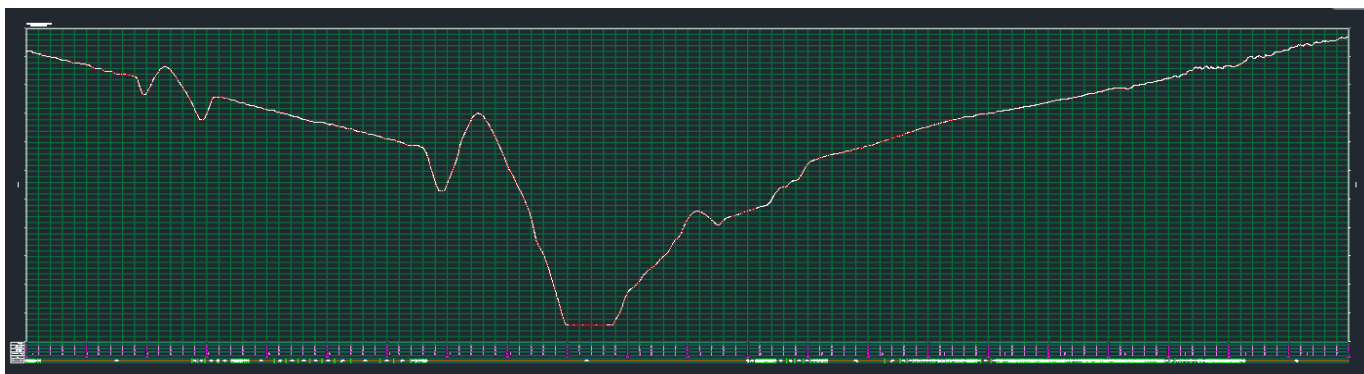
Perfil longitudinal del terreno en AutoCAD Civil 3D.
